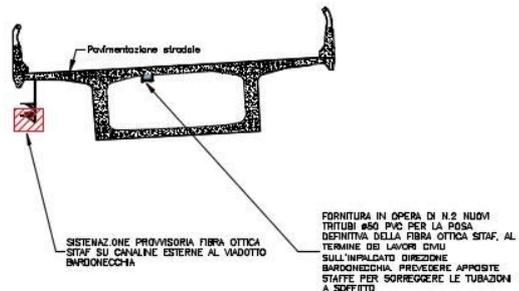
Viadotto Clarea – Posizione fibre ottiche internazionali FASE 2
